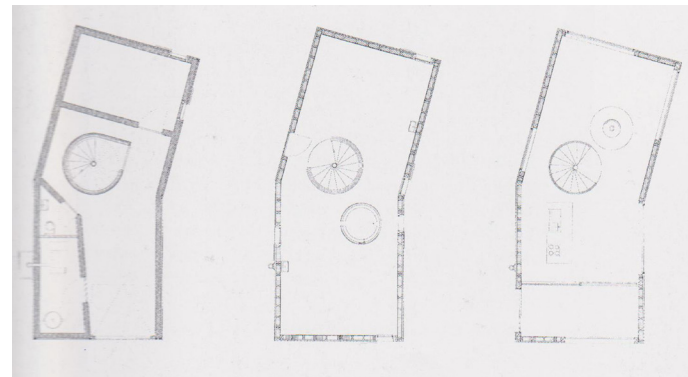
| Grundrisse Kellergeschoss, Mittelgeschoss und Obergeschoss
